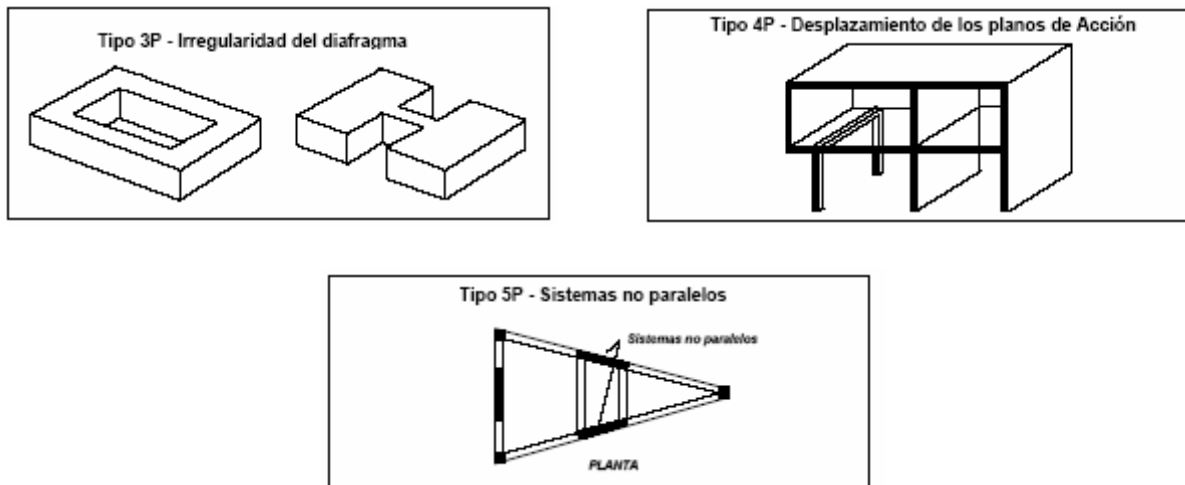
Irregularidades en planta de la estructura NSR-98
